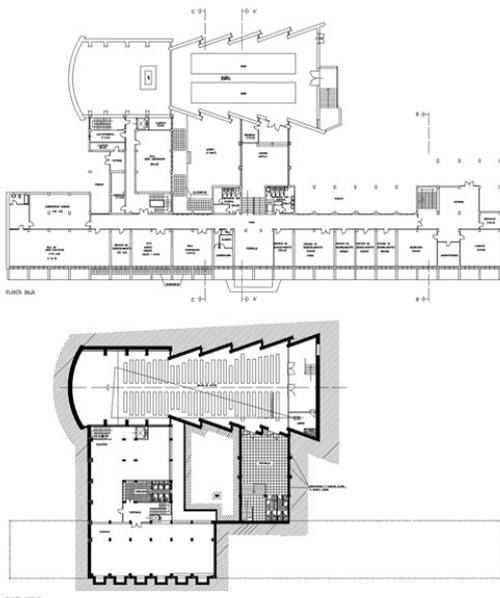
Planta baja y sótano del Colegio Pureza de María. Fuente: COACV
